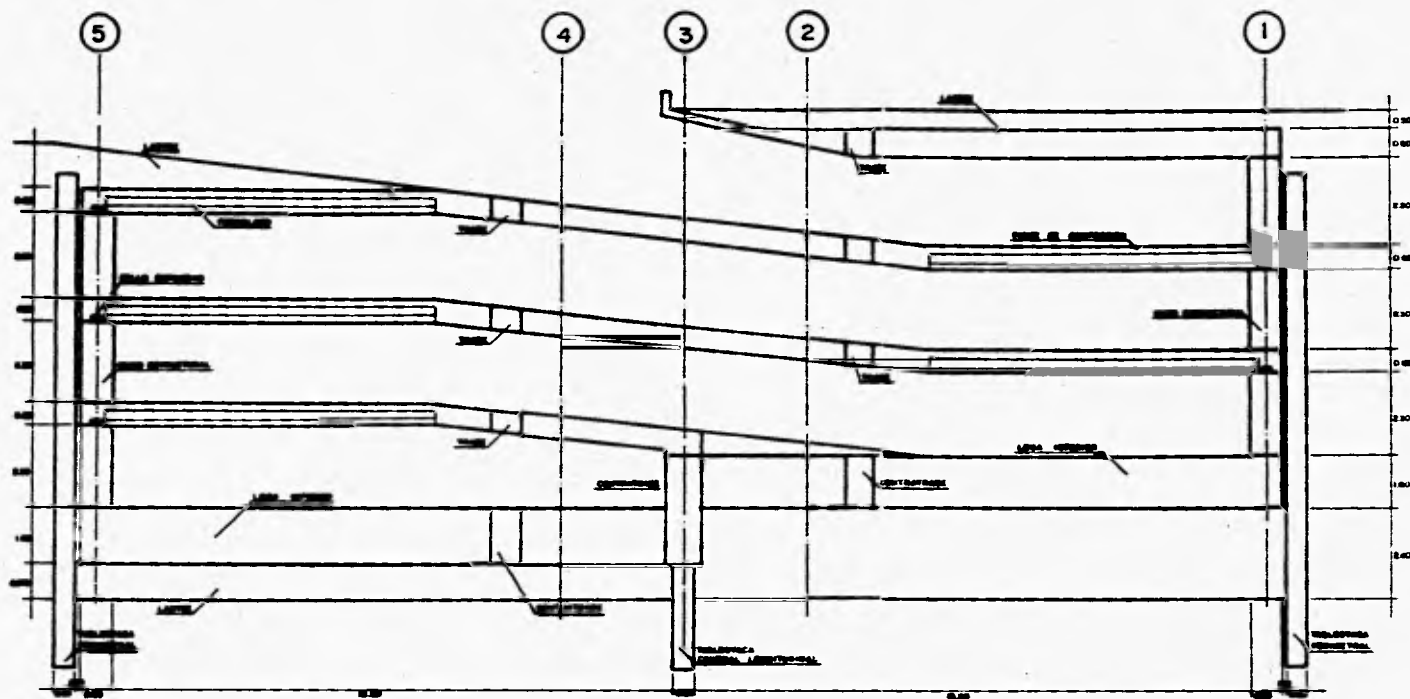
Corte transversal en zona de rampas del Estacionamiento Plaza Bellas Artes.
